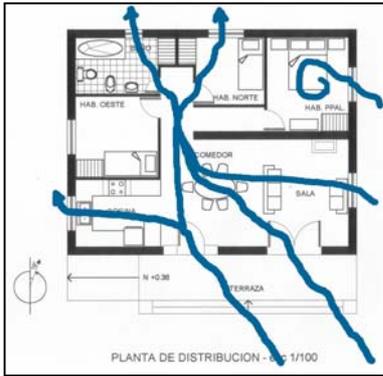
Esquema de movimiento del aire en planta de la casa 1.
